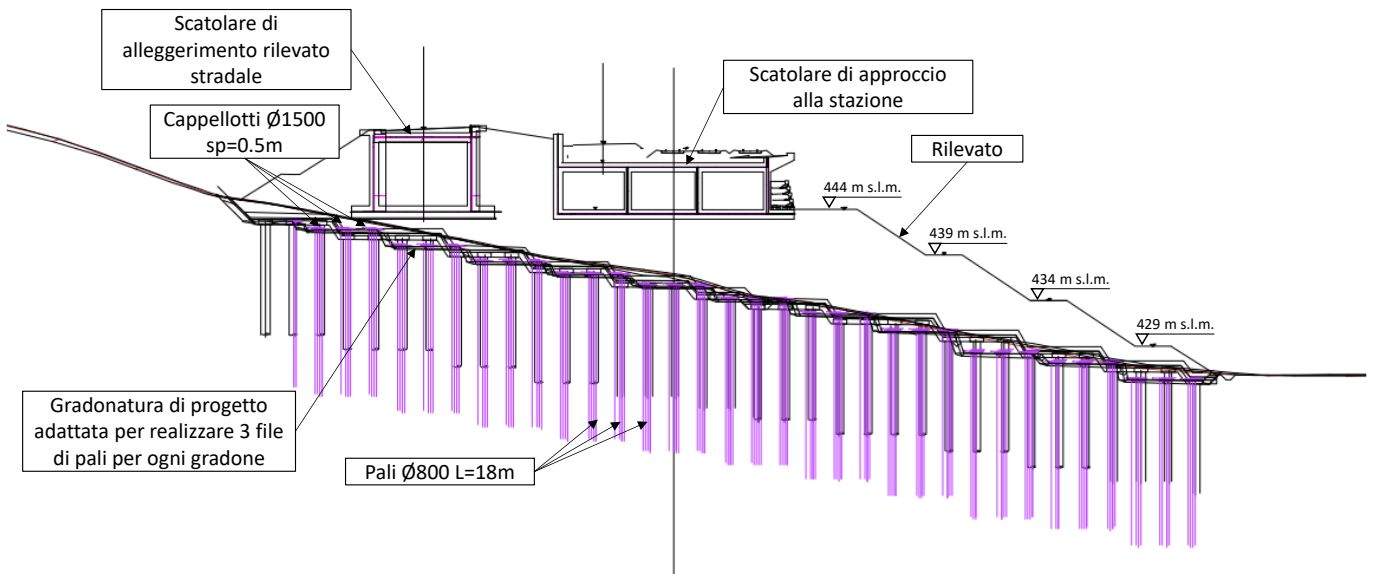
Sezione 14. Sovrapposizione tra sezione di progetto e porzione di geometria implementata nel modello
